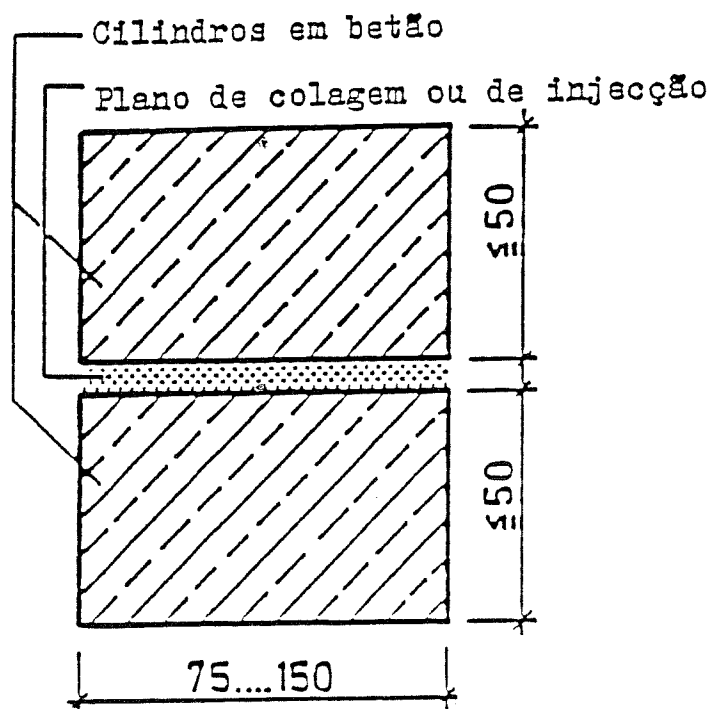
Dimensões (mm) do provete cilíndrico.
